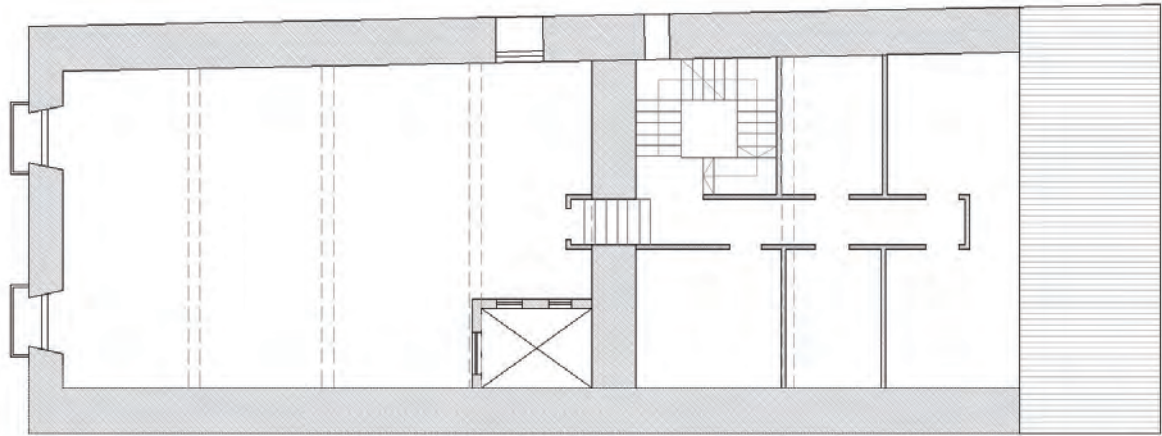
12. PLANTA BAJOCUBIERTA
